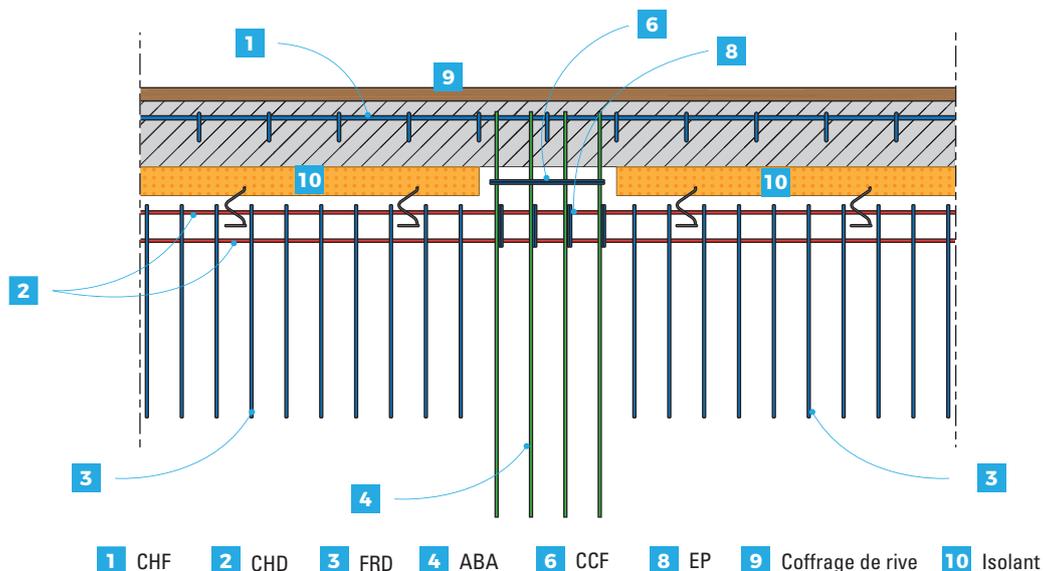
Solution 1 – Voile arasé en sous-face de dalle : Exemple de dispositions de ferrailage – Vue en plan
